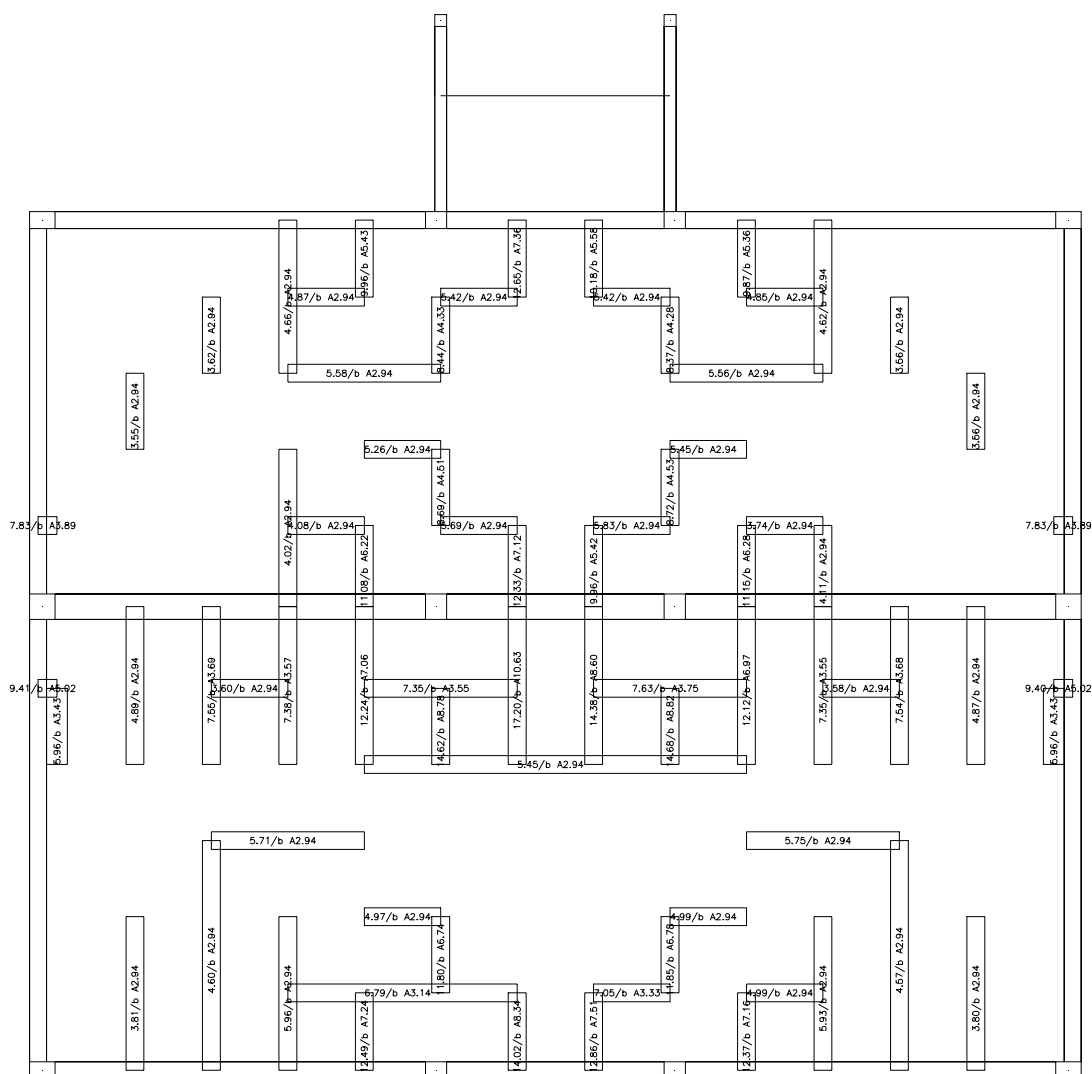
Prédio “C” – Opção 7 – Regiões onde se precisa armar a laje ao cisalhamento com a consideração de rótula sobre a viga central V2
